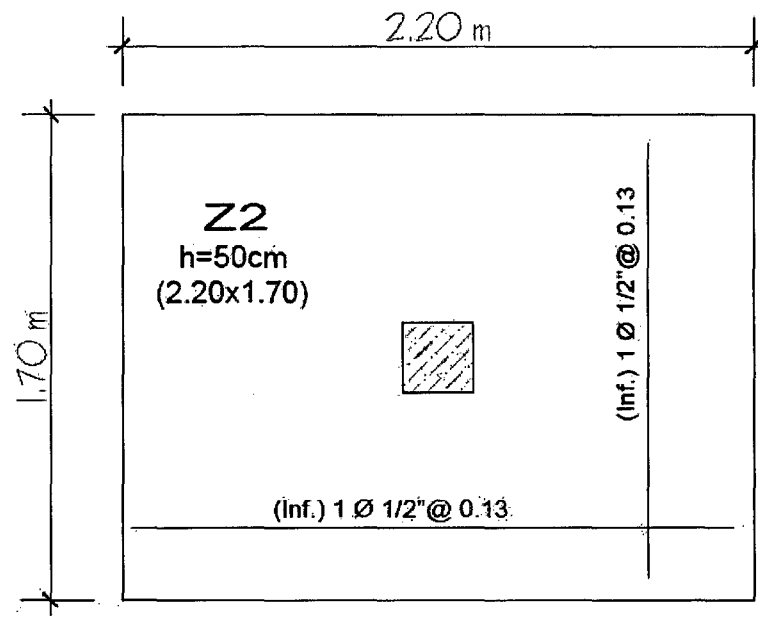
Distribución final del refuerzo para zapata Z-2.
